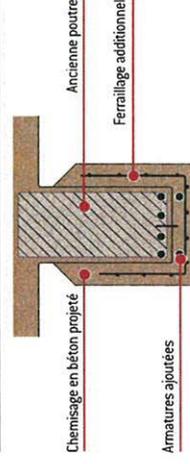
Exemple de renforcement d'une poutre par béton projeté (coupe transversale)
